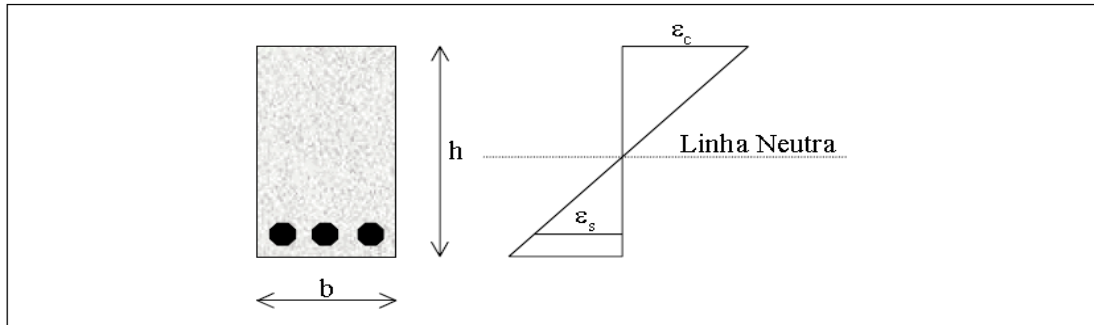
Distribuição linear de deformações em viga de concreto armado
